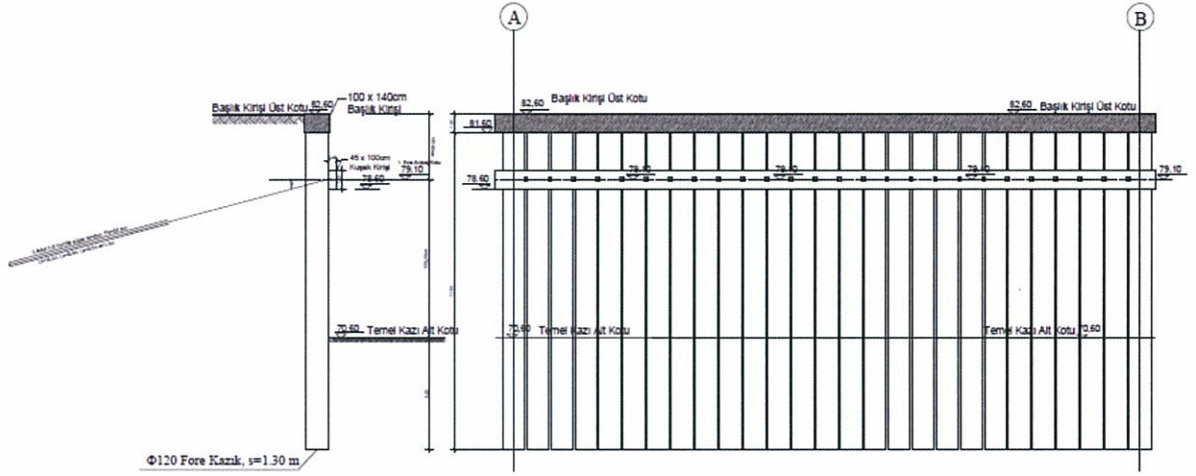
B01-B – B22-B ve B23 Blok iksa kazıkları yerleşim planı
